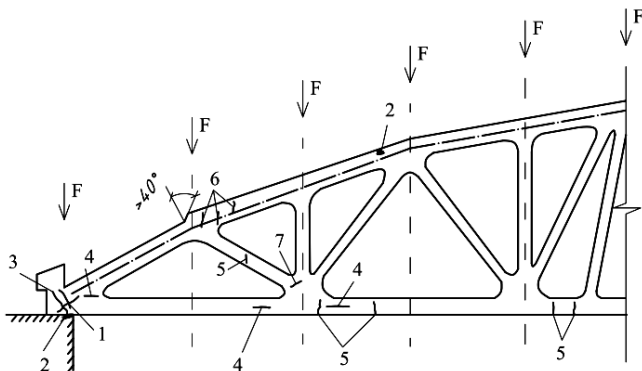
Характерные повреждения силового происхождения в железобетонных фермах с нижним предварительно напряженным поясом:
